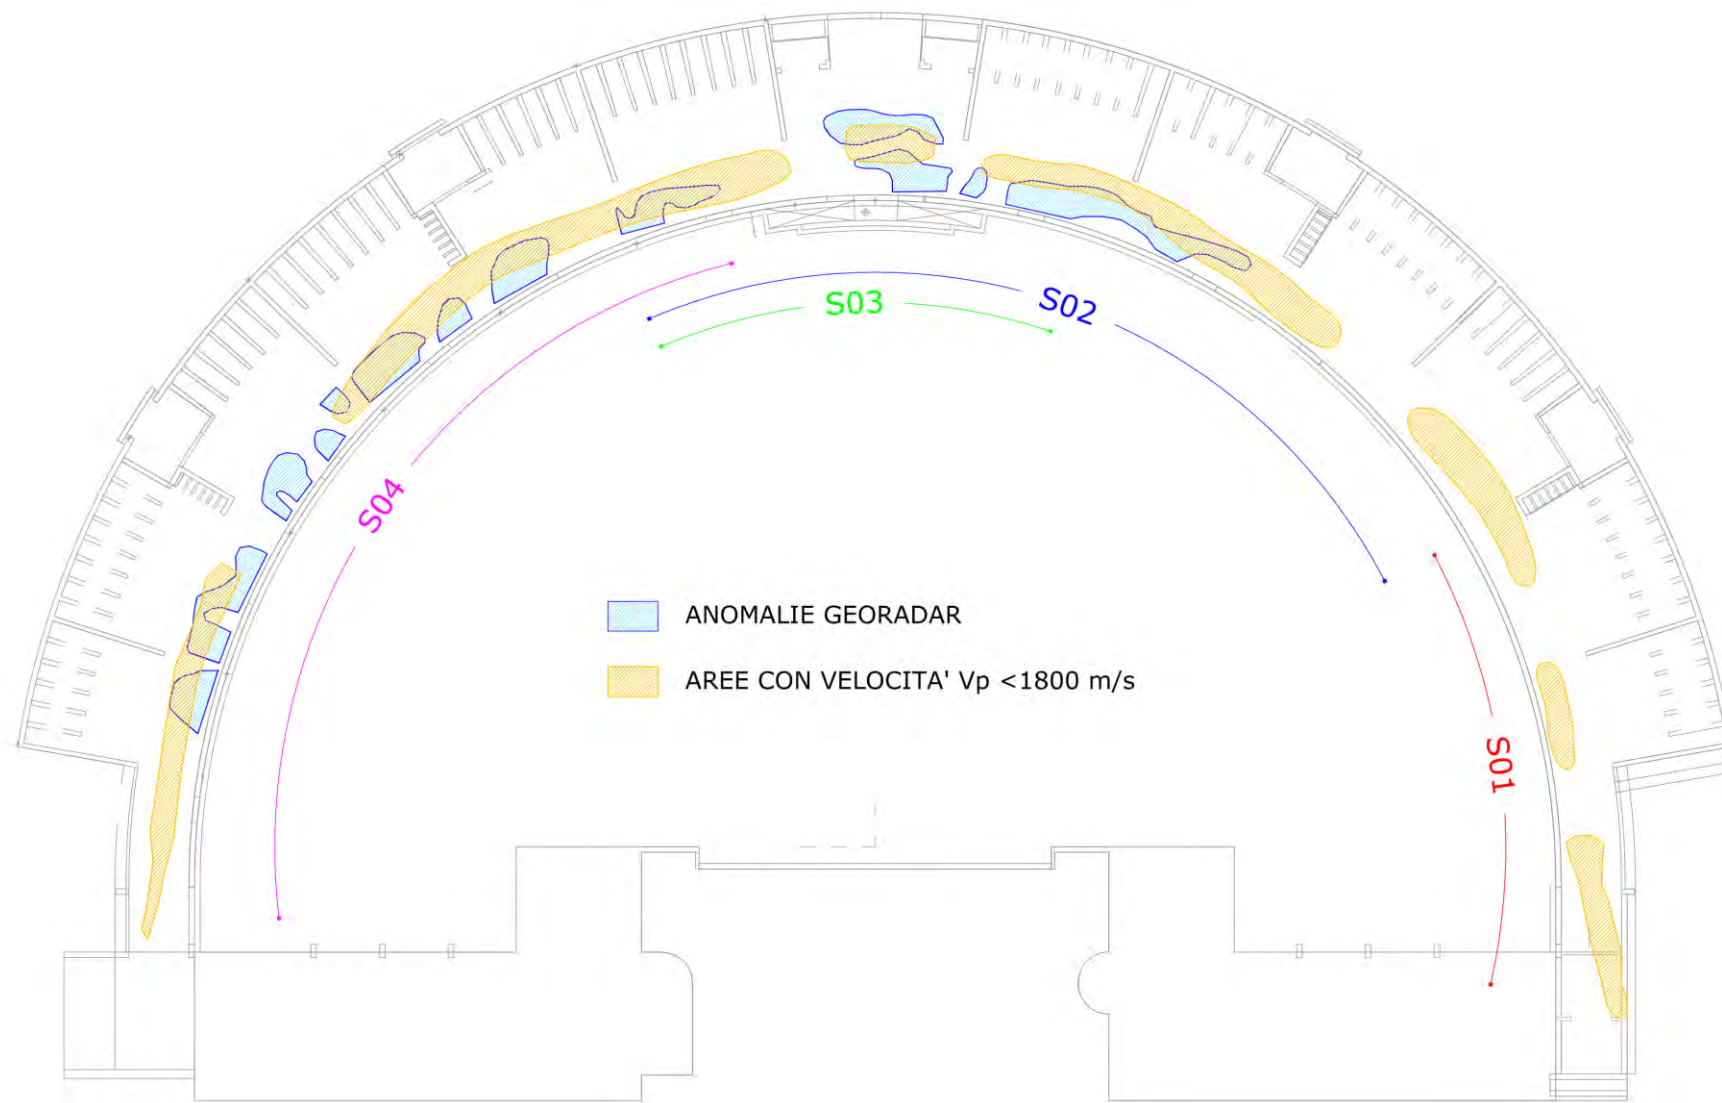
Inquadramento planimetrico anomalie rilevate
